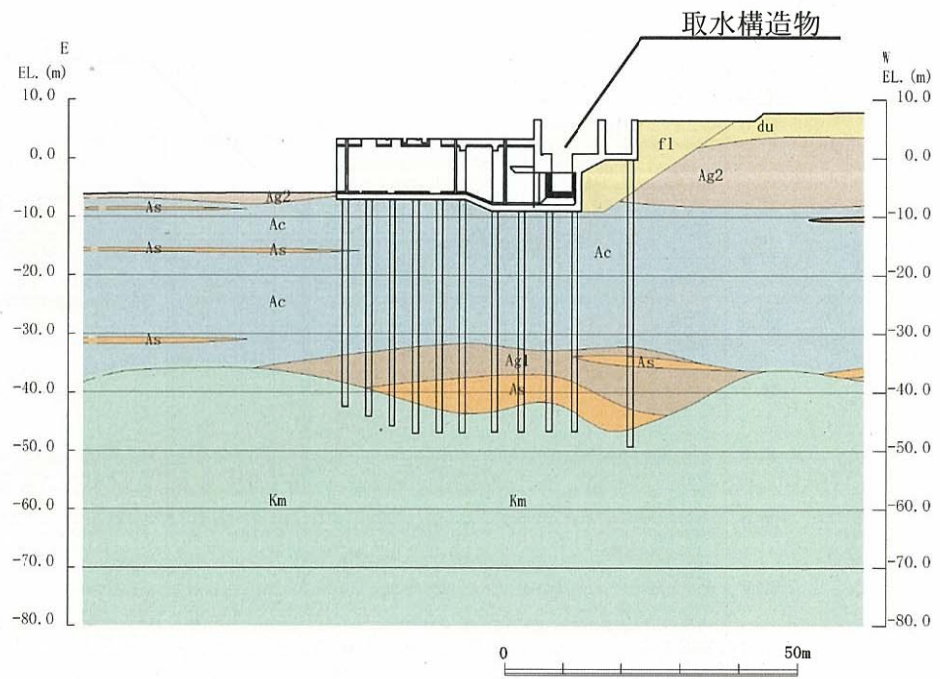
(3) 地質断面图 (⑥-⑥断面)
